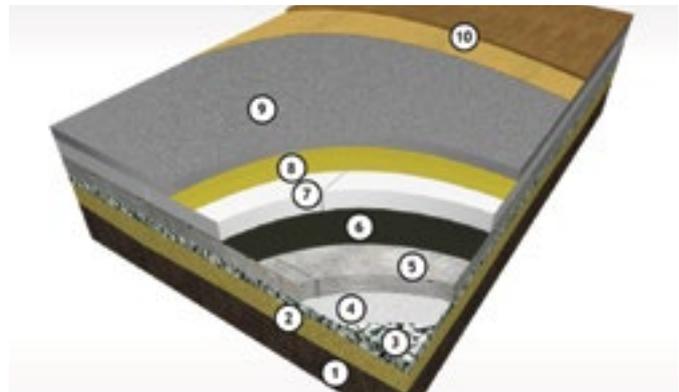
„Schwimmender“ Estrich mit Fußbodenheizung – Aufbau:
